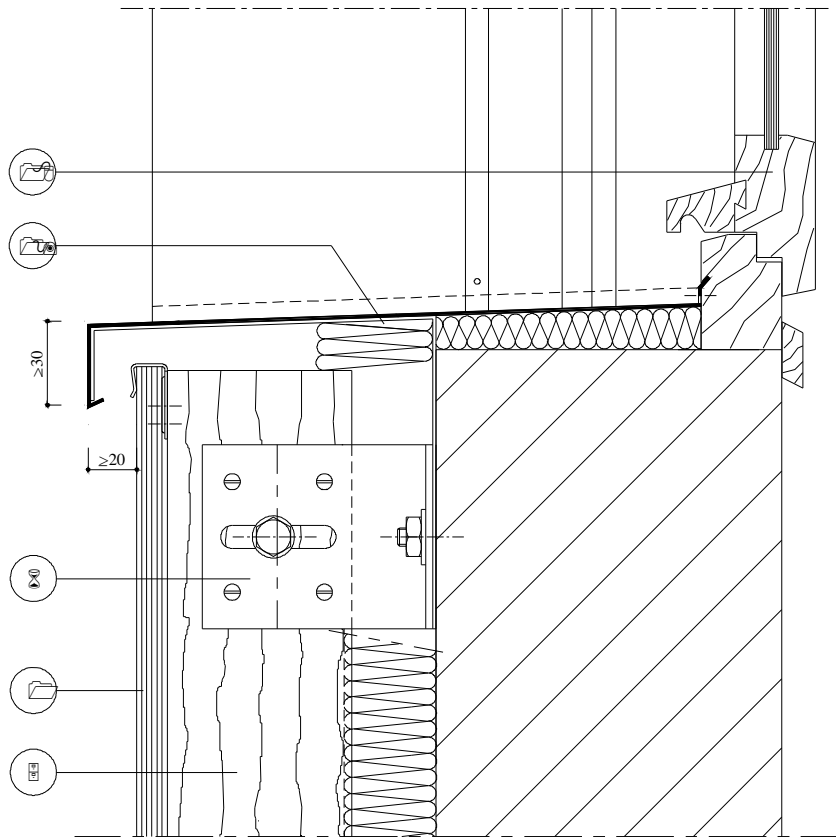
Appui de baie – Coupe verticale – Ossature bois
